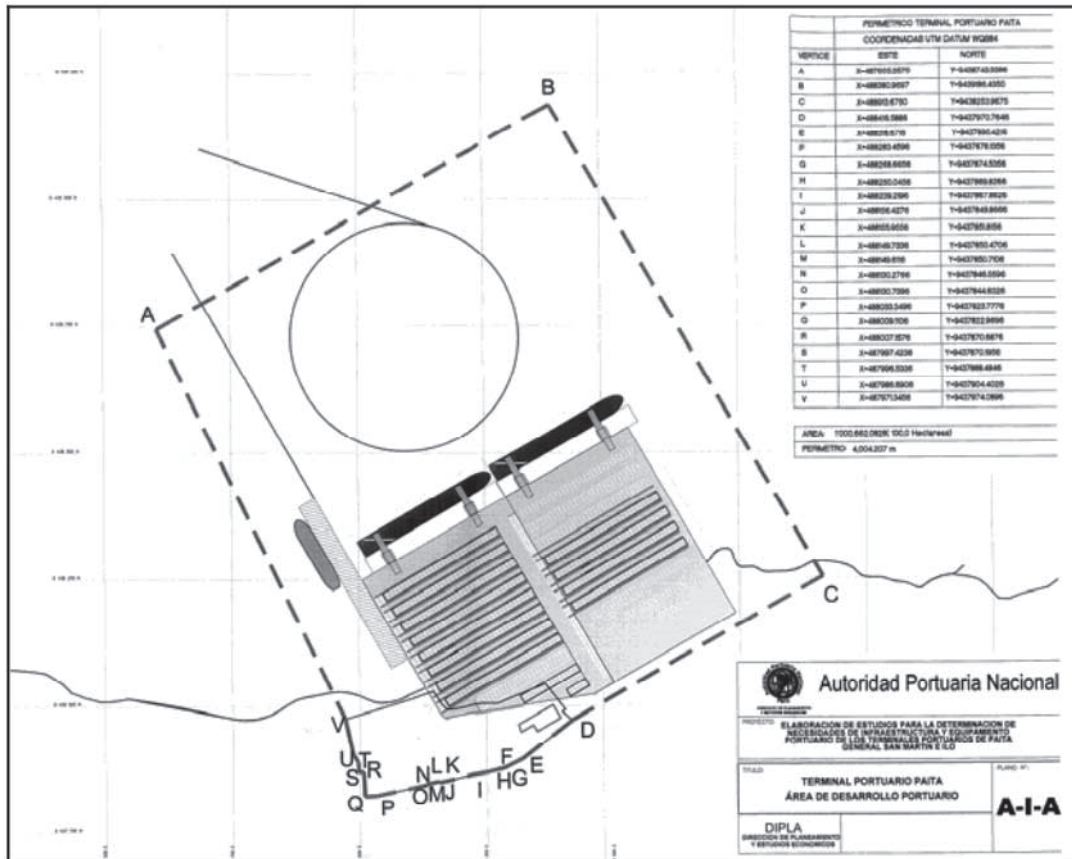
Plan de desarrollo del Puerto de Paita
